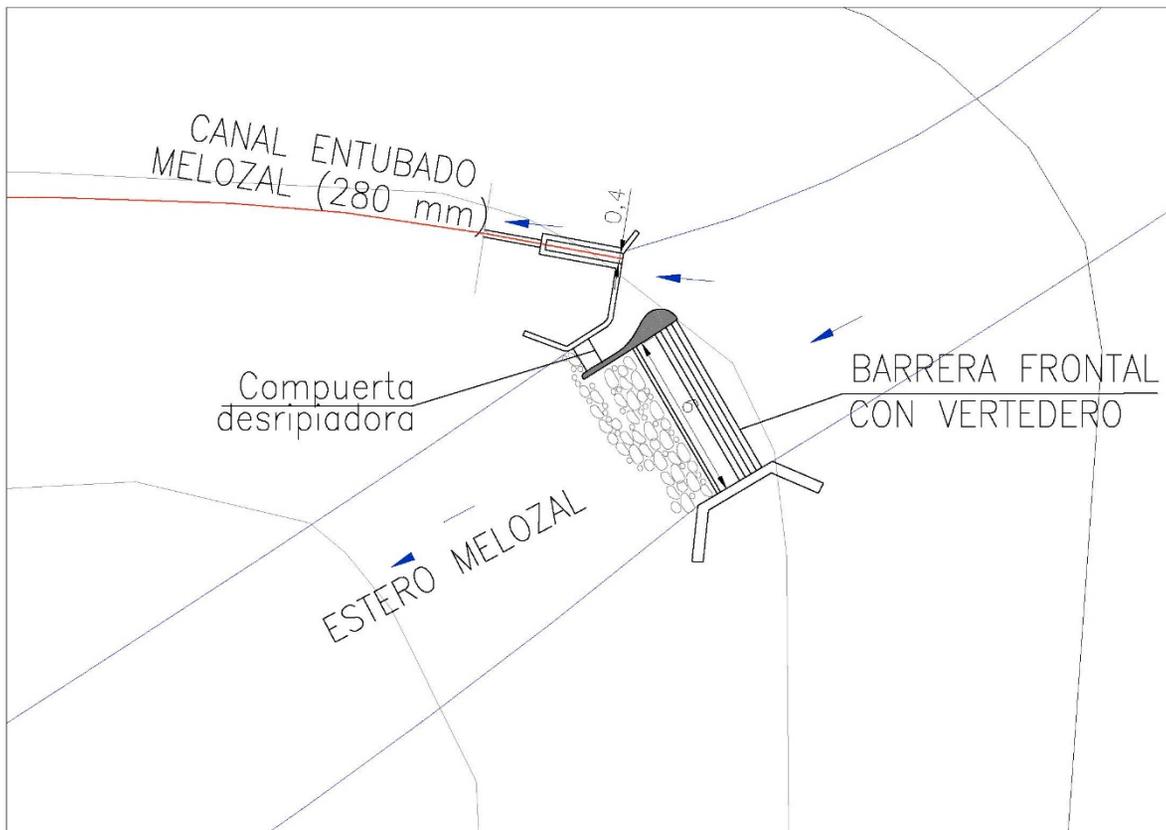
Esquema Bocatoma Canal Entubado Melozal
